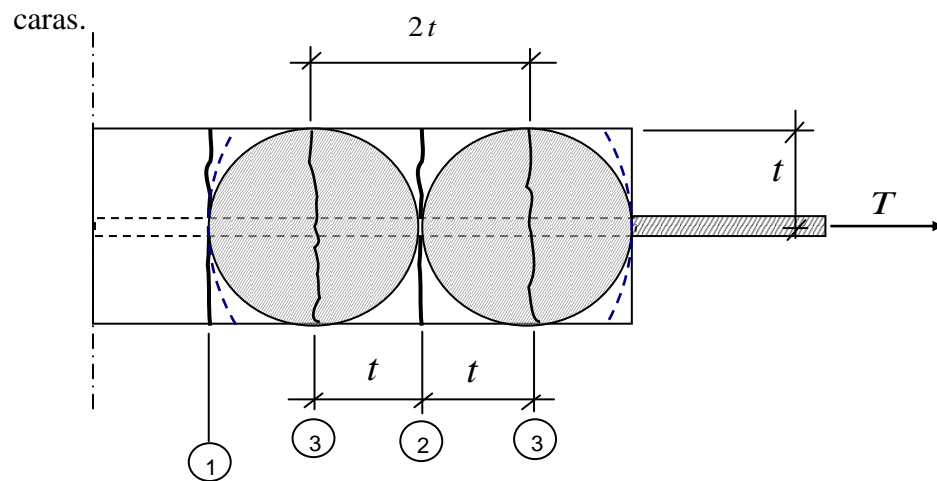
Separación de fisuras según el mecanismo propuesto por Bross.
